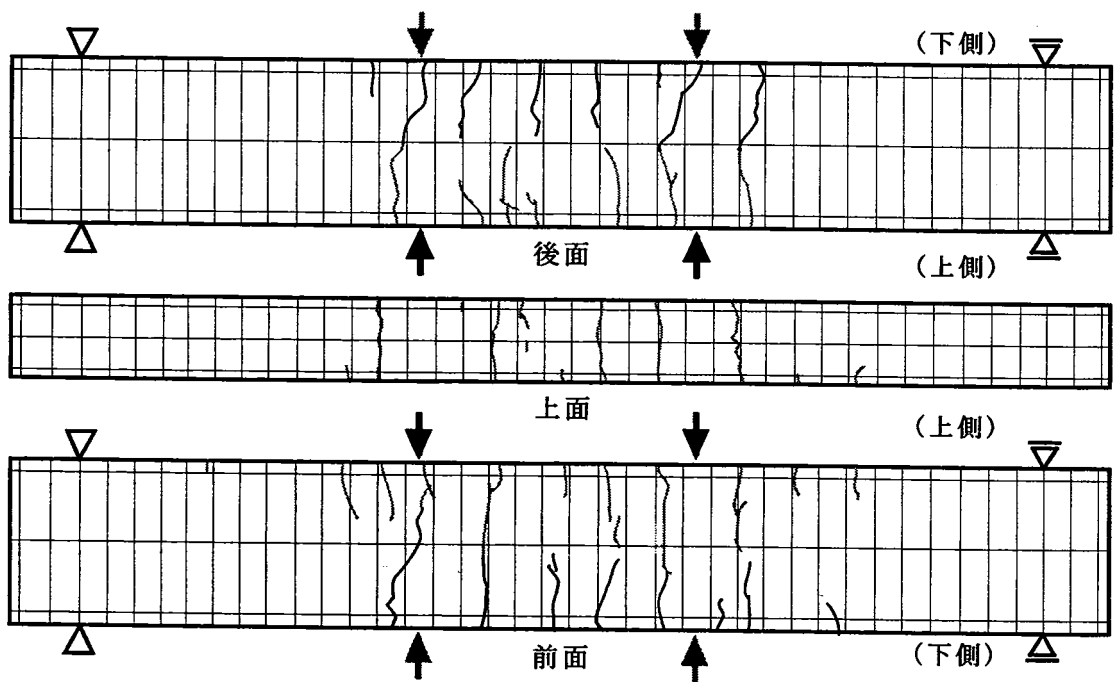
b) ひび割れ性状 [BS-3 ; R = 1/800rad.]
